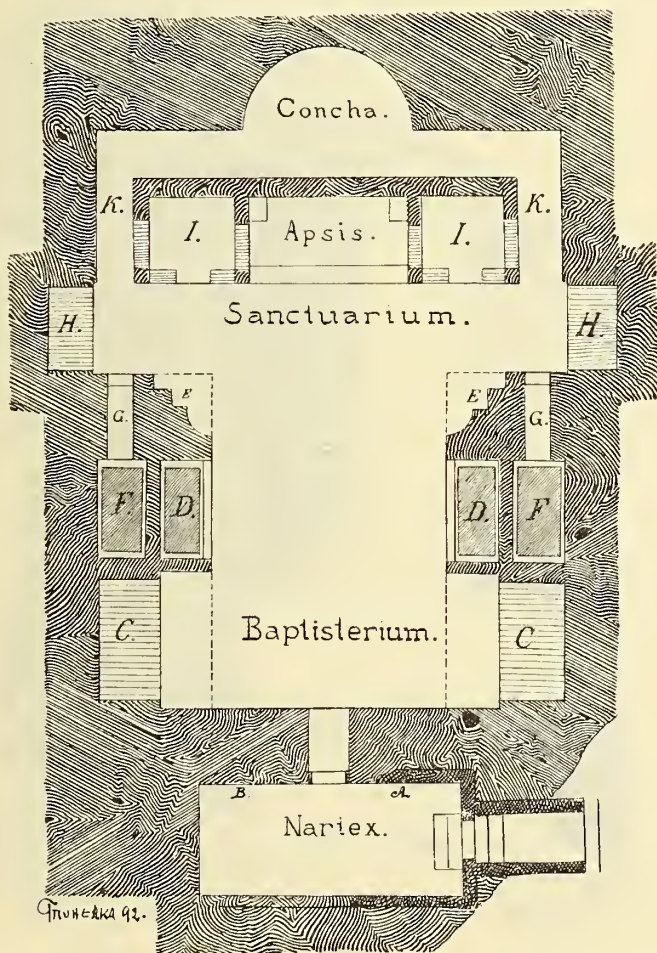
Beabsichtigter Grundriss der Gruftkirche von Jajce.
